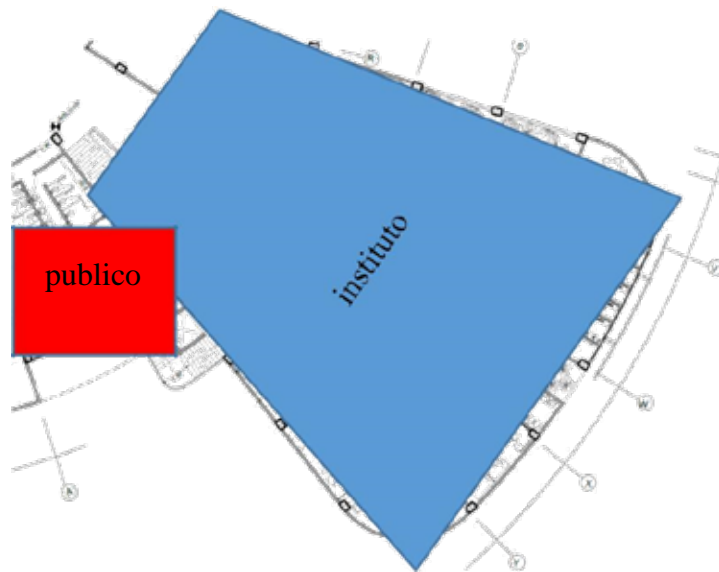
Esquema de funcionamiento en locales exteriores. Planta baja. (2016)
